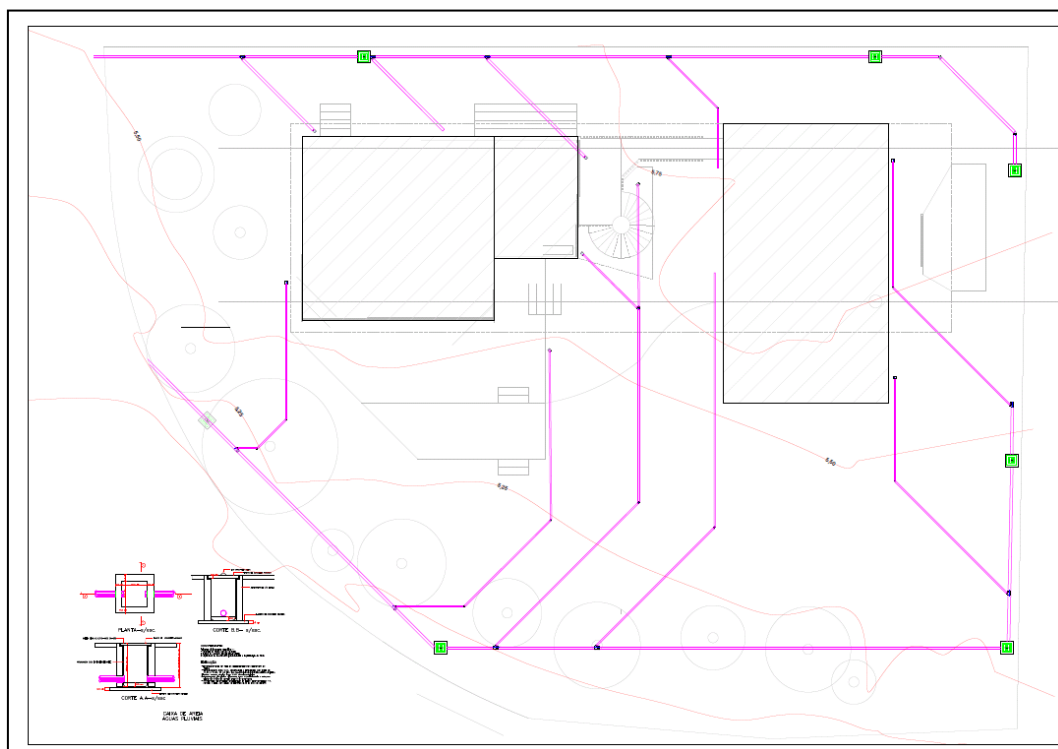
Configuração de águas pluviais no pavimento térreo. Fonte: AUTOR (2017).
